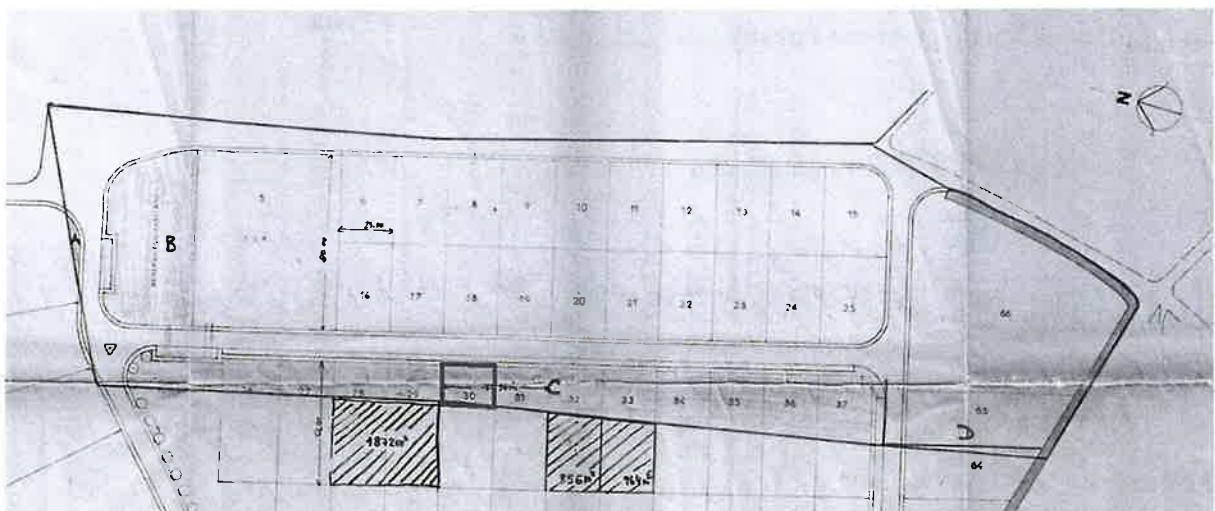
Planta Síntese do Loteamento n.º 01/1985
